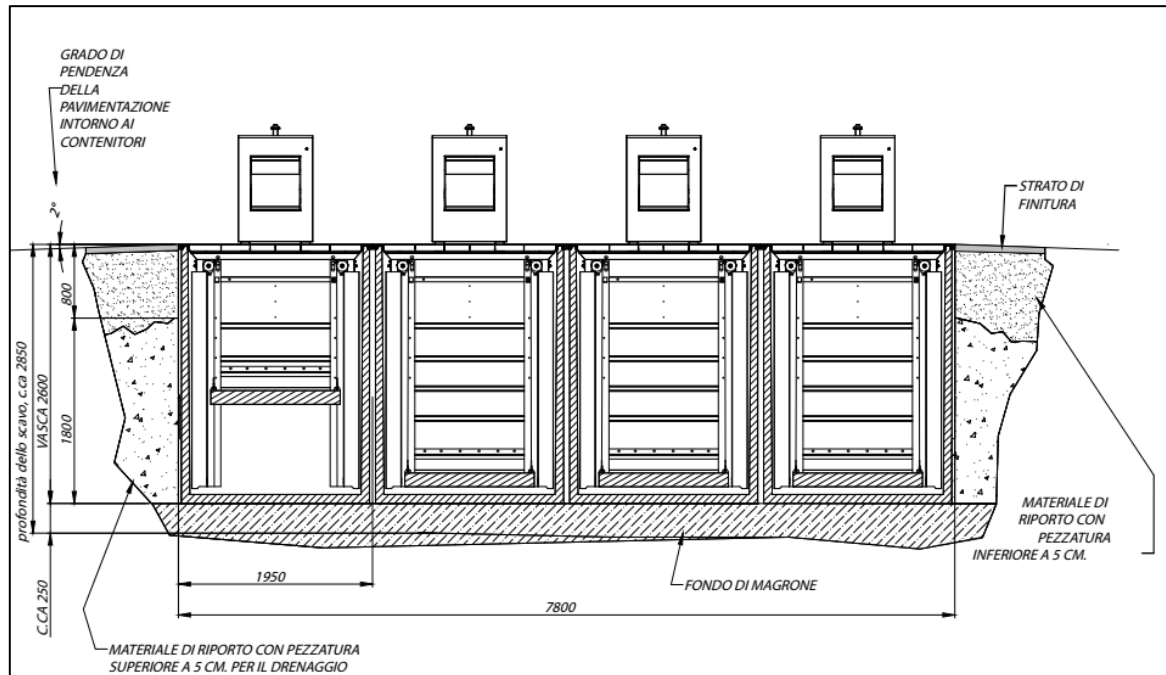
Vista frontale sistema di installazione isole ecologiche interrato di tipo “Underground” / Ditta Nord Engineering
